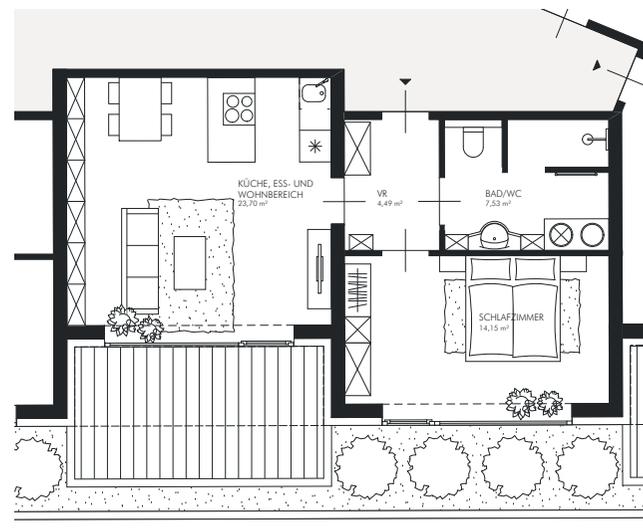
Grundriss mit Möblierung | Wohnung 2 | M 1:150
